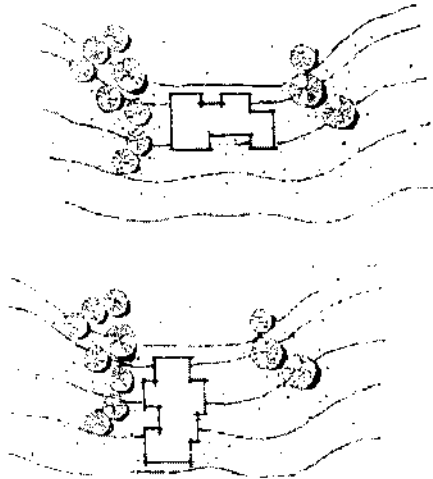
Las construcciones deben de adaptarse a la topografía natural del terreno (imagen superior), evitando diseños la modifiquen substancialmente (imagen inferior).
